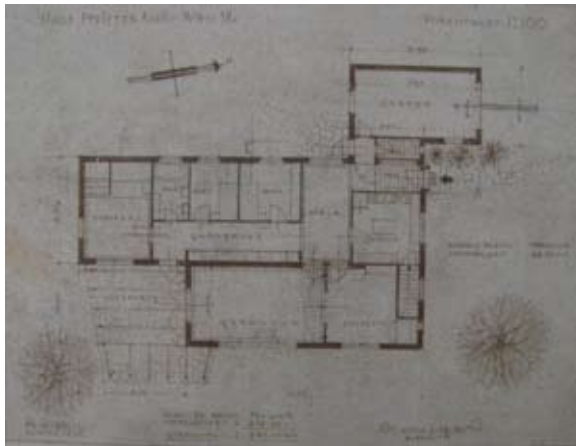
Plan 27.1: Anton Valentin. Haus Pfeiffer Rudi – Wien 13. Vorentwurf. Grundriss. Pl. Nr. 8801. Maßstab 1:100. Jänner 1956.
